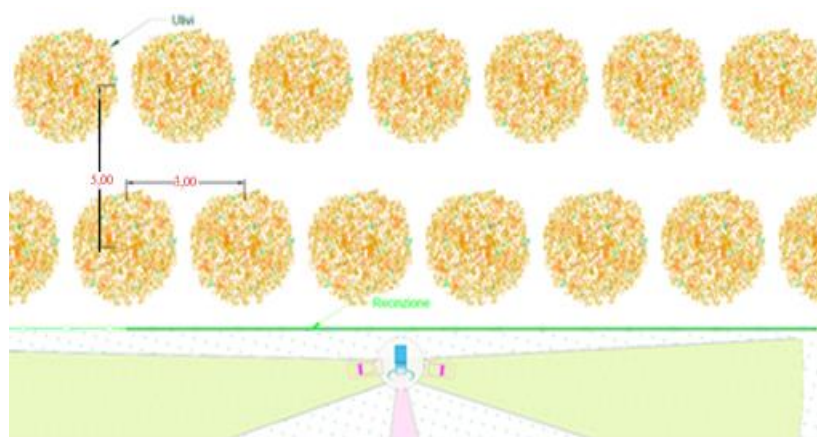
Planimetria esplicativa della distribuzione delle piante all'interno della fascia
